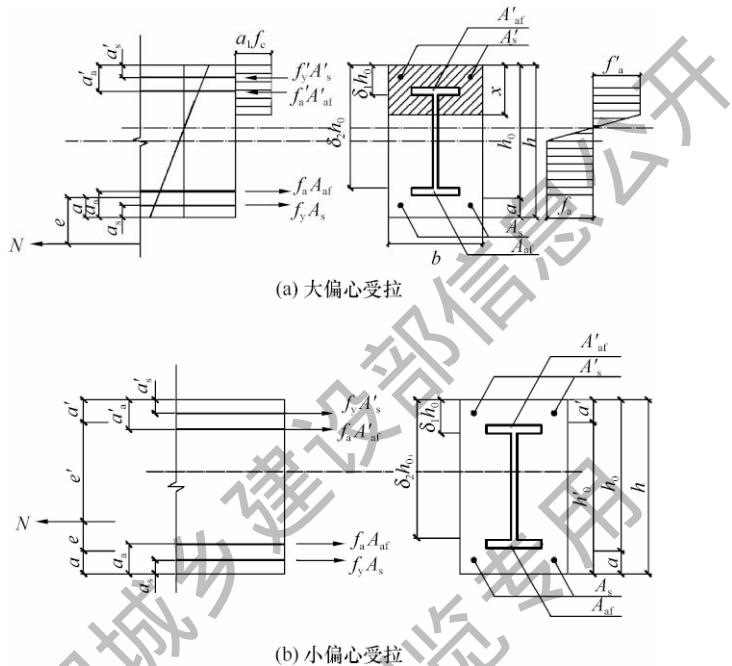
偏心受拉框架柱和转换柱的承载力计算参数示意
